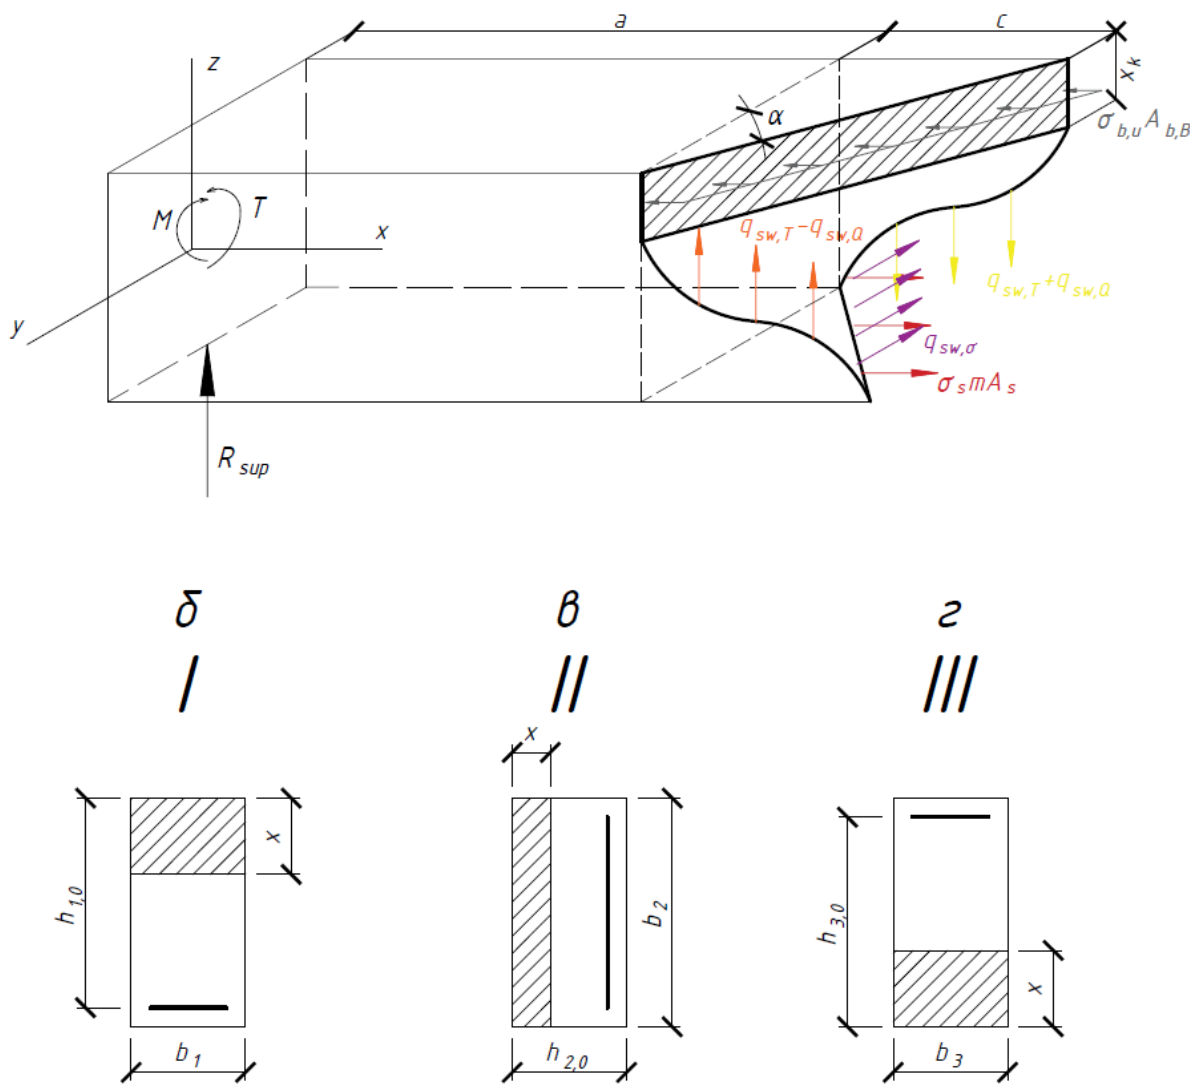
Усилия в пространственном сечении (а) и схемы (I, II, III) расположения сжатой зоны (б – г) в железобетонном элементе при изгибе с кручением
